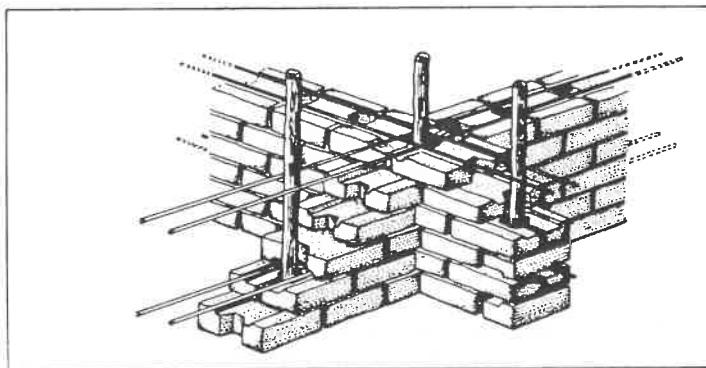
MAMPOSTERIA DE BLOQUES DE TIERRA REFORZADA. CRUCE DE LOS MUROS
